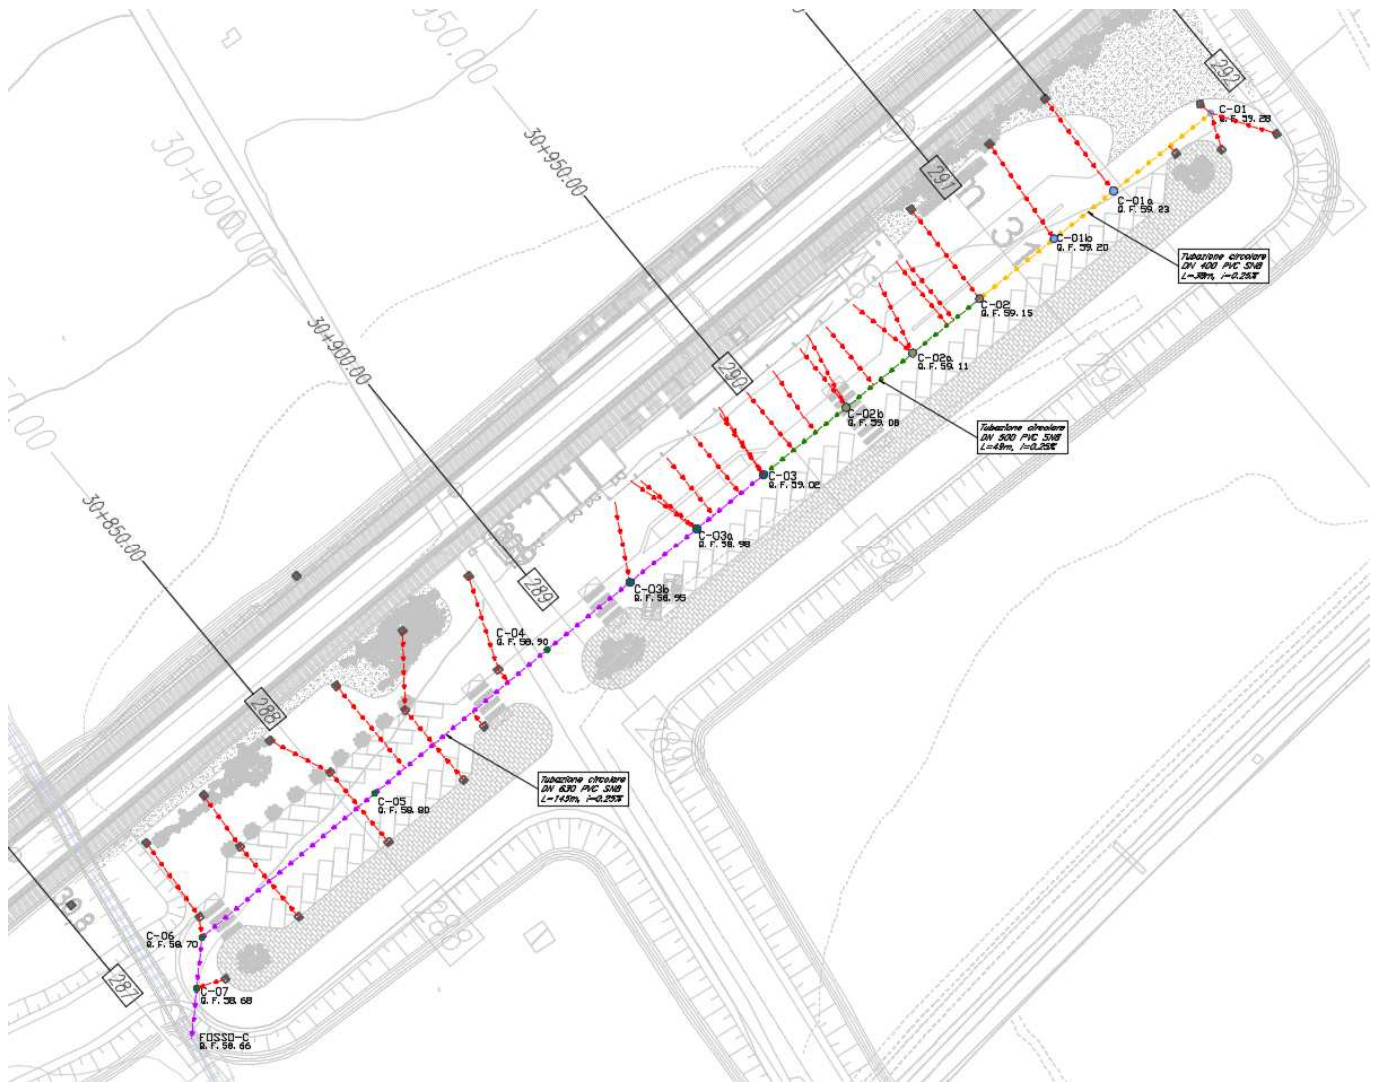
Stazione di Solopaca, sistema di drenaggio.
